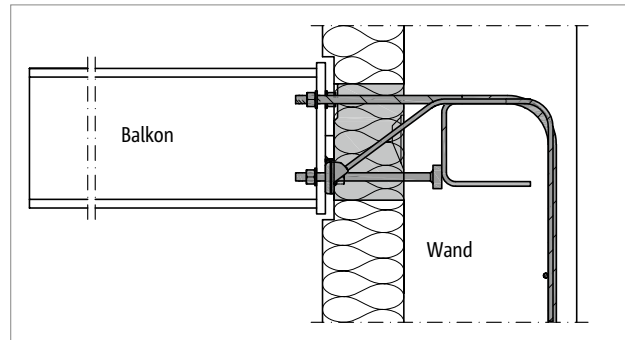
Schöck Isokorb® XT Typ SK-WU-M1: Sonderkonstruktion für Wandanschluss auf Basis der Haupttragstufe M1 für Wandstärken ab 200 mm
